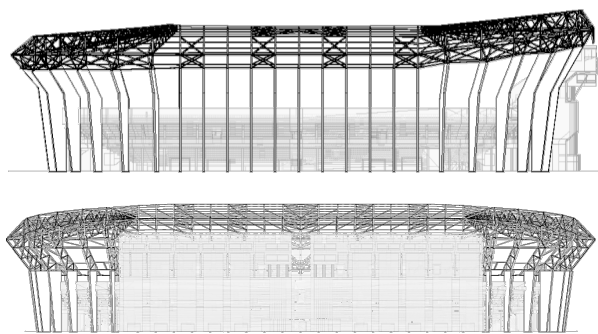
Alzado este/oeste (arriba) junto a alzado preferente (abajo)
